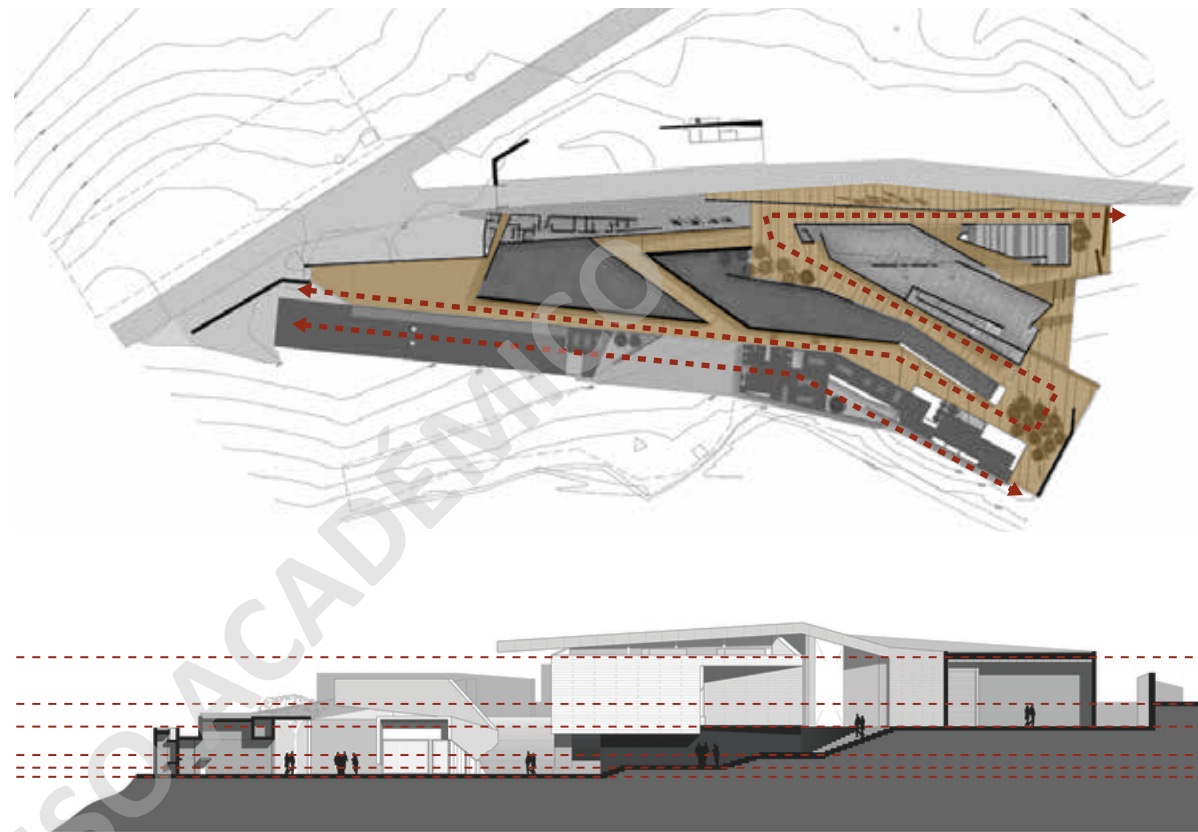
esquema recorrido Museo de sitio Pachacamac. Elaboración propia intervención planta y corte de arquitectura.
